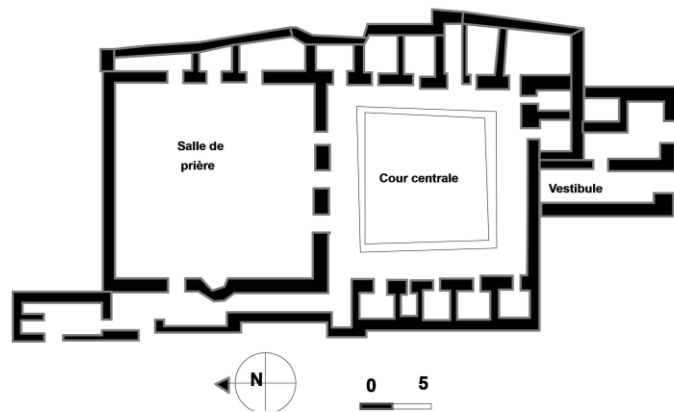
Vue en plan de la medersa el-Bâchiyya
